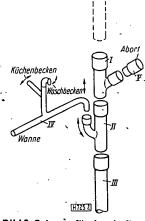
Schema für den Aufbau einer Abflußanlage aus typisierten Fertigbauteilen. Fallrohrelemente für sämtliche Grundrißtypen anwendbar
